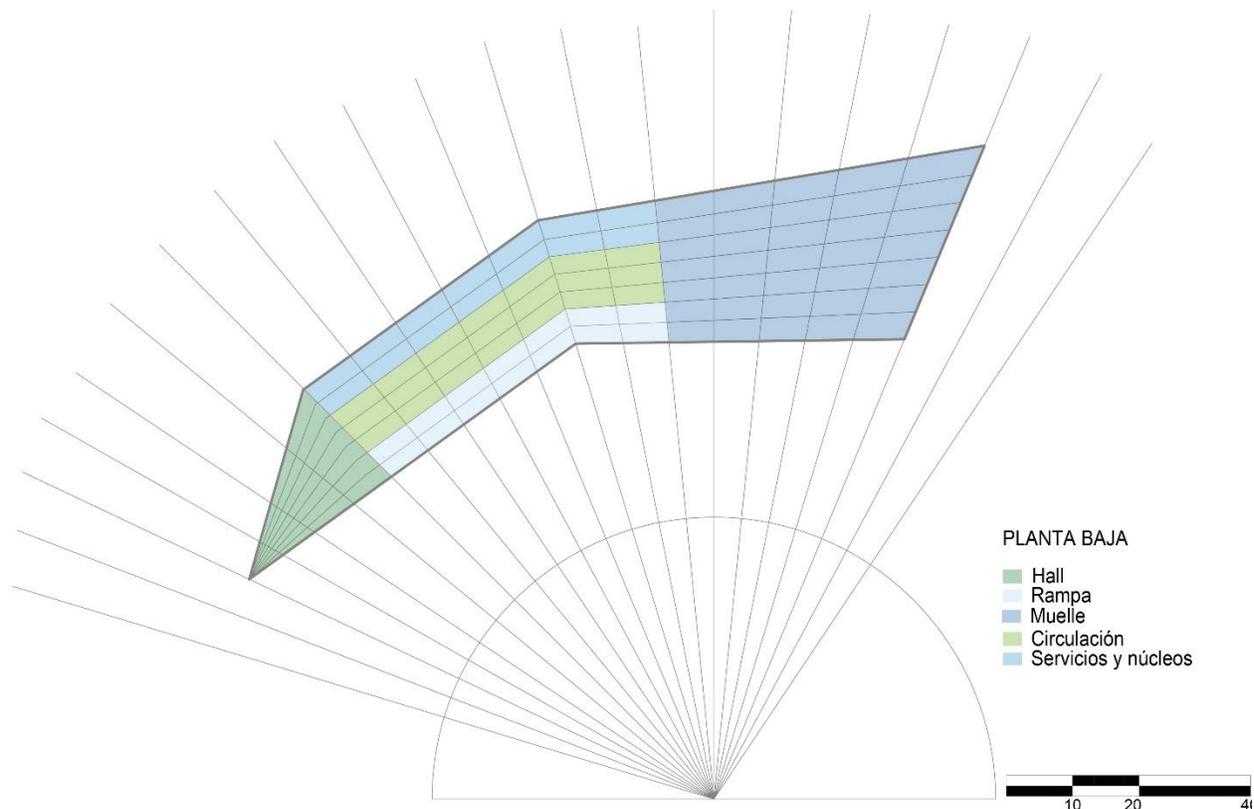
Zonificación de Planta Baja. Elaboración propia.
